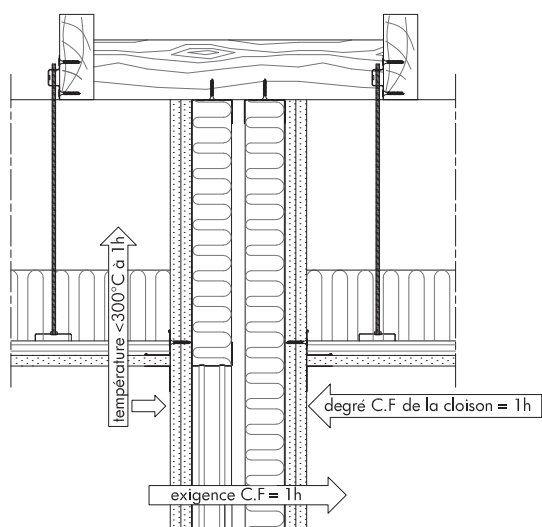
Cloisons fixées sous la structure - ERP type U
